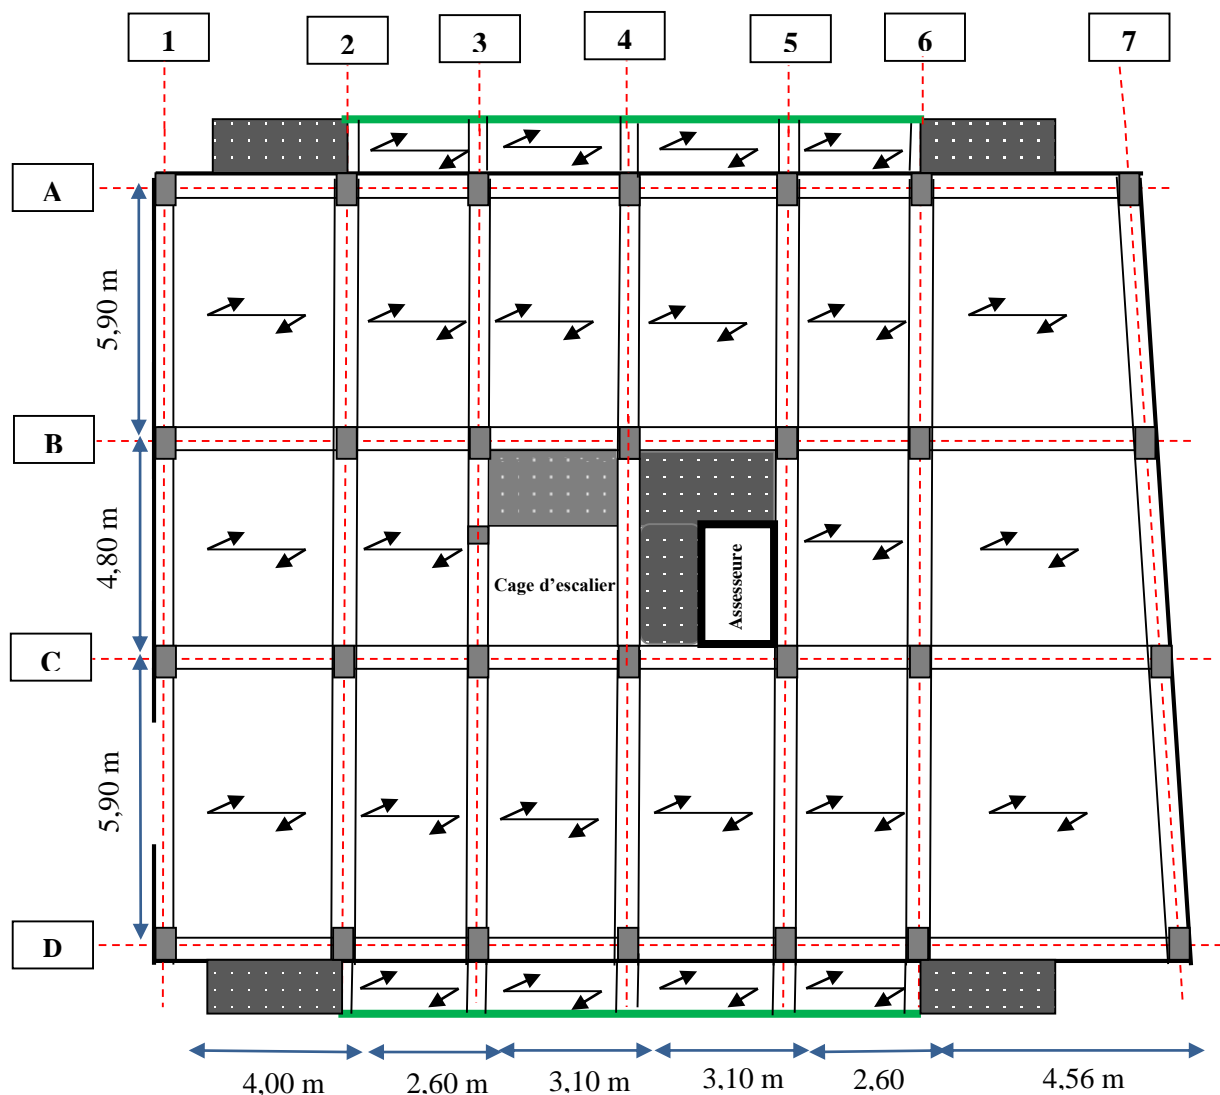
Plane de disposition des poutrelles étage 1 à 9
